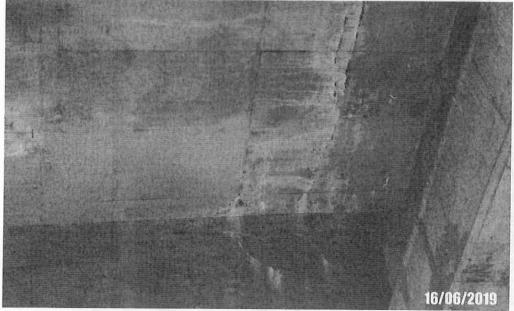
Detalhe de fissura e infiltração na face inferior do tabuleiro.
